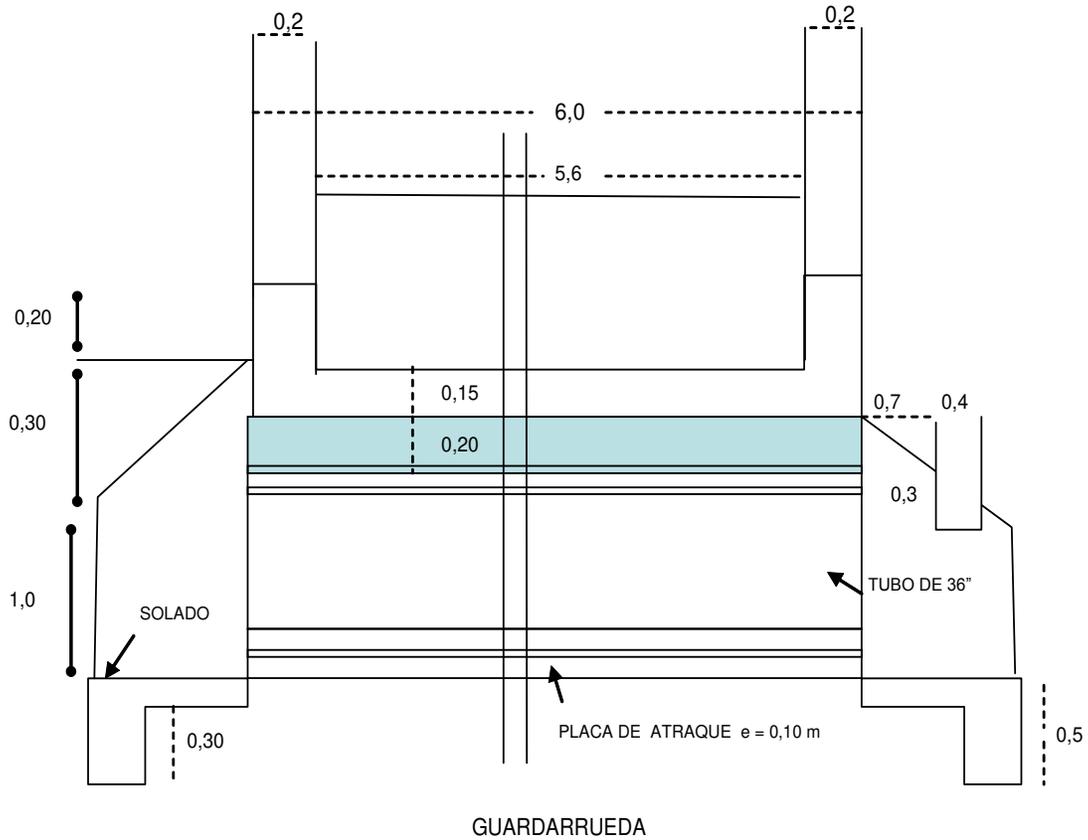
Vista frontal y lateral de una alcantarilla tipo para las vías de acceso.
